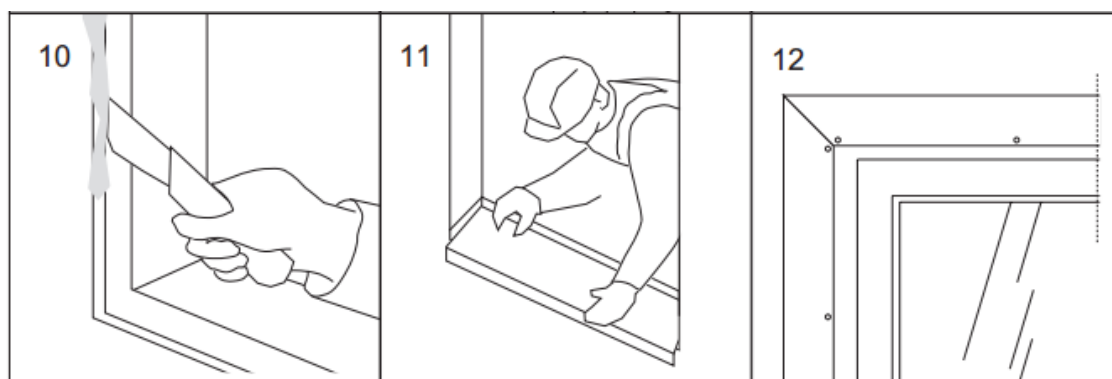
Fönsterinstallation (RT 41-10947 2009, 14).
